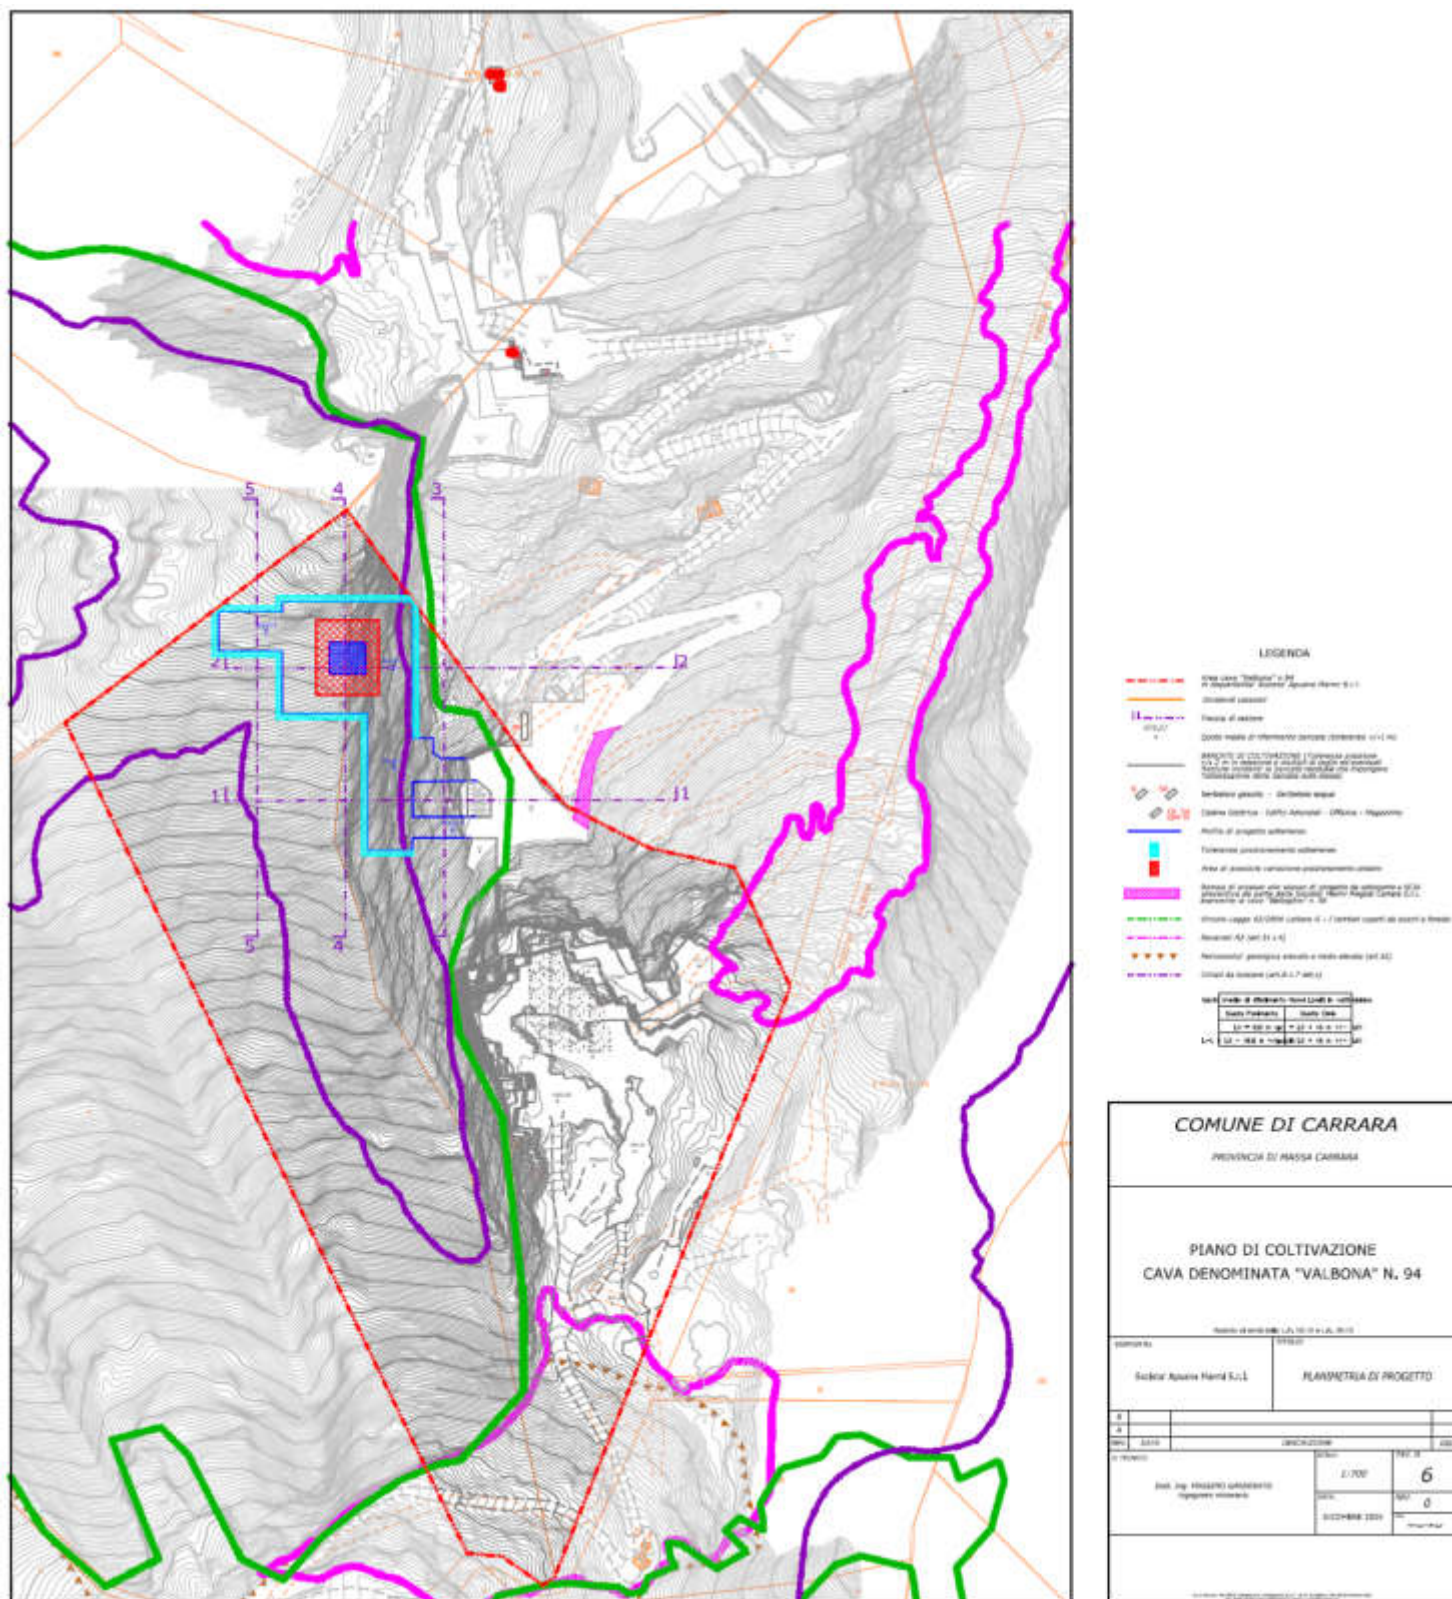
planimetria stato di progetto elaborata dal progettista Dott. Ing. Massimo Gardenato.
